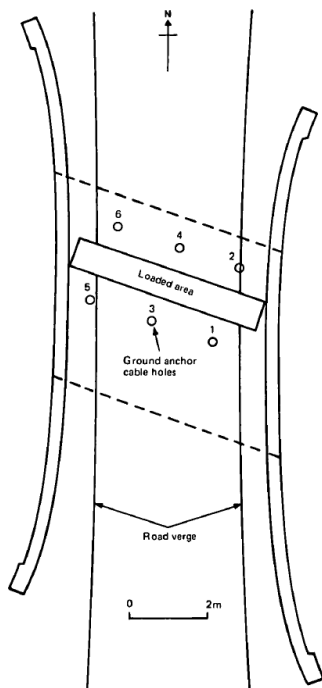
Preston Bridge*: planimetria con schema di disposizione del carico e dei fori per l'ancoraggio dei martinetti. [47]
